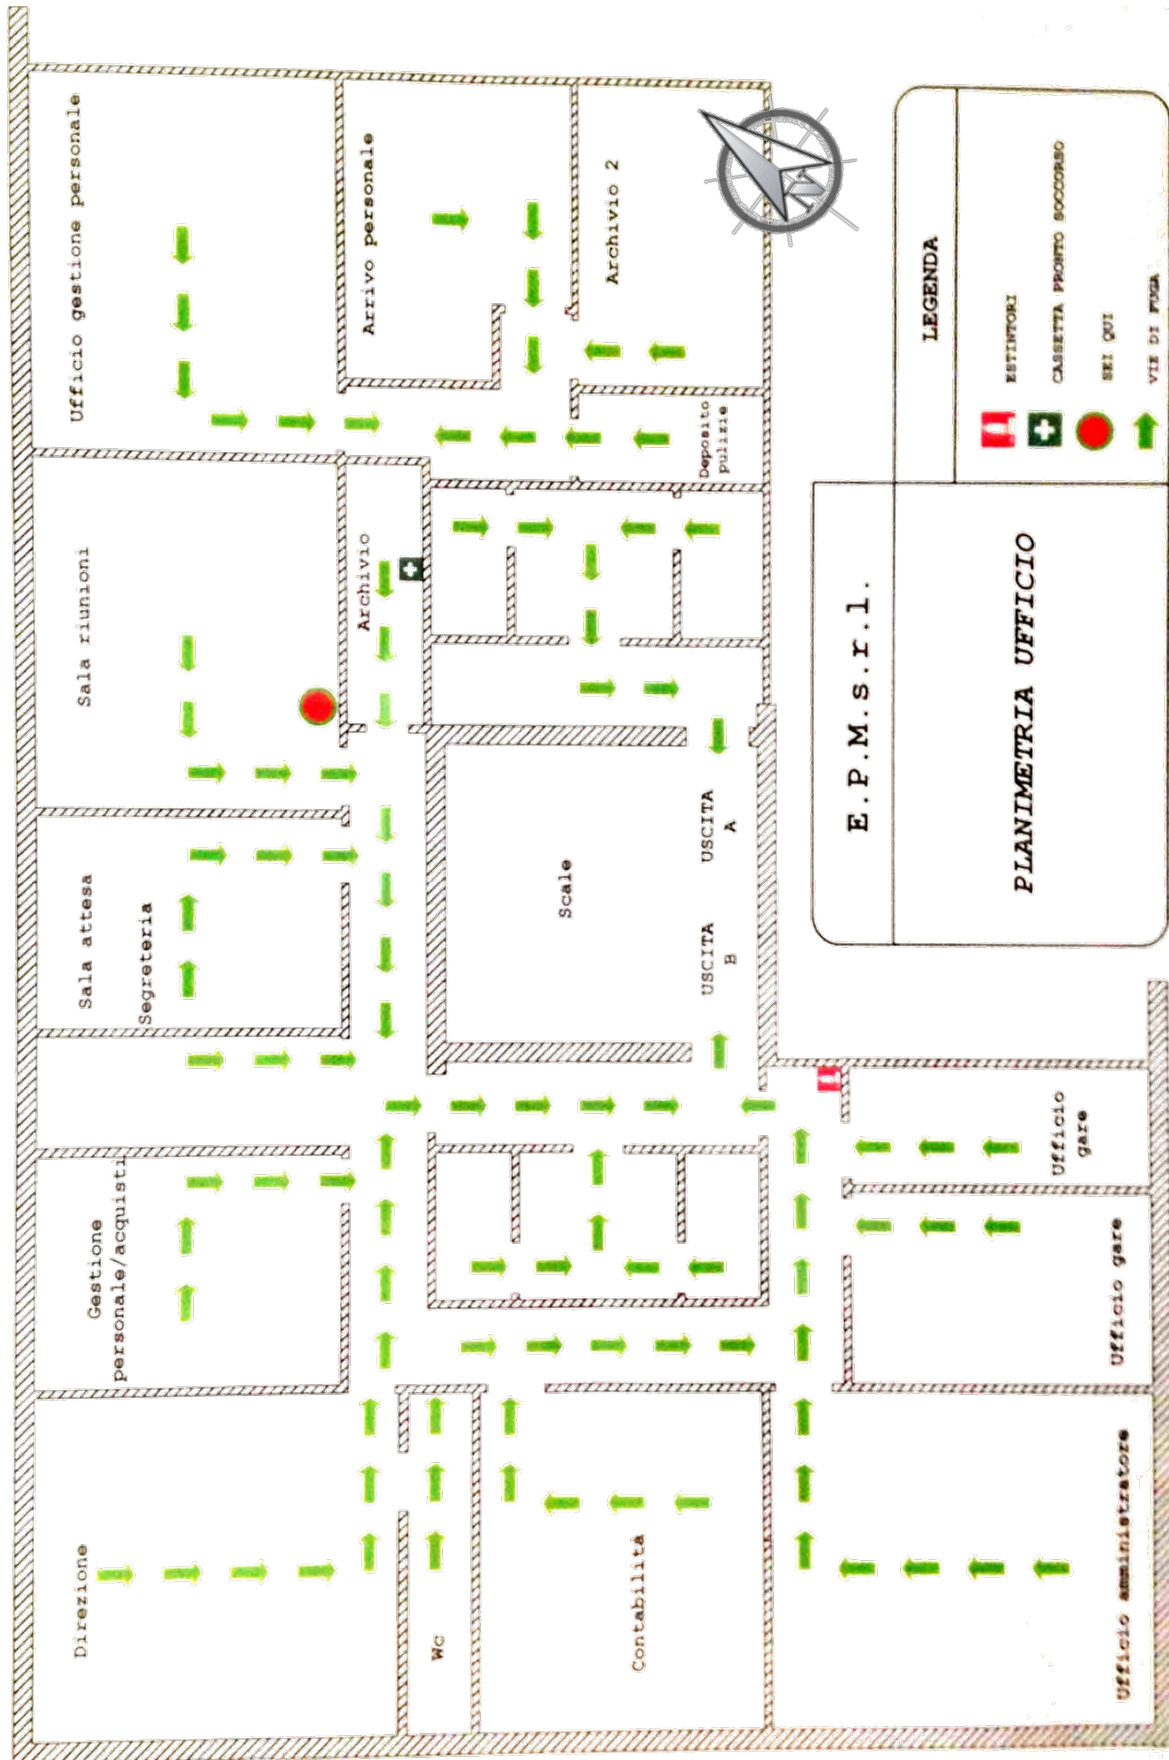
Planimetria degli uffici EPL, Isola A2 - Centro Direzionale di Napoli, Secondo piano – Scala 1:100
